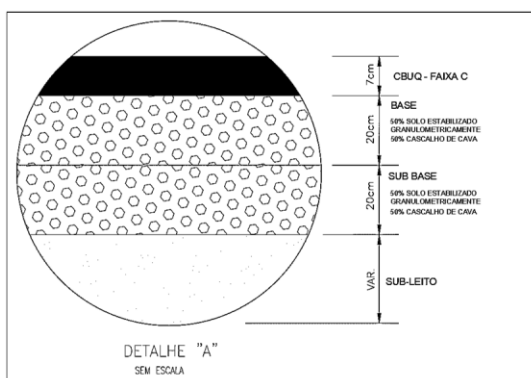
Detalhamento da Seção Tipo Pavimentação
